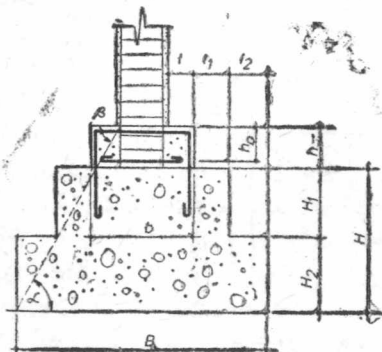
Fundație cu bloc din beton simplu și cuzinet din beton armat.
